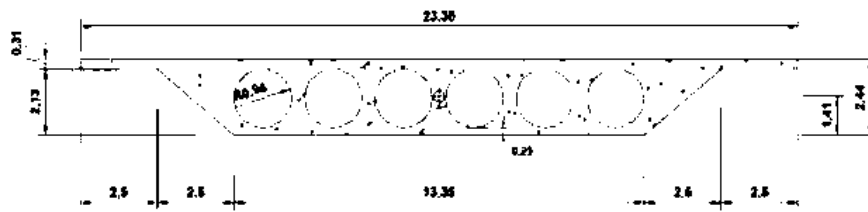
Diseño de losa aligerada. (ocw, s.f.)
